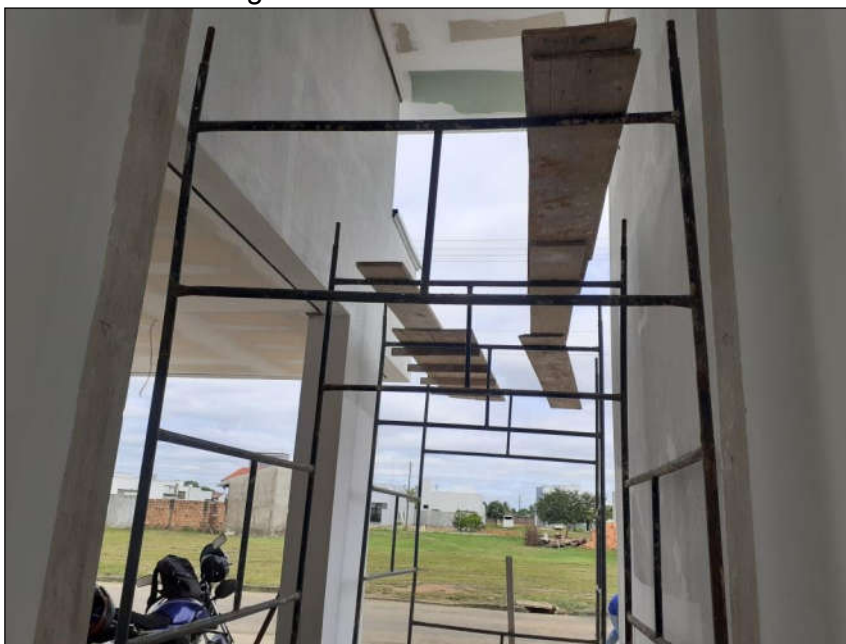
Empilhamento das madeiras retiradas da obra 2.
